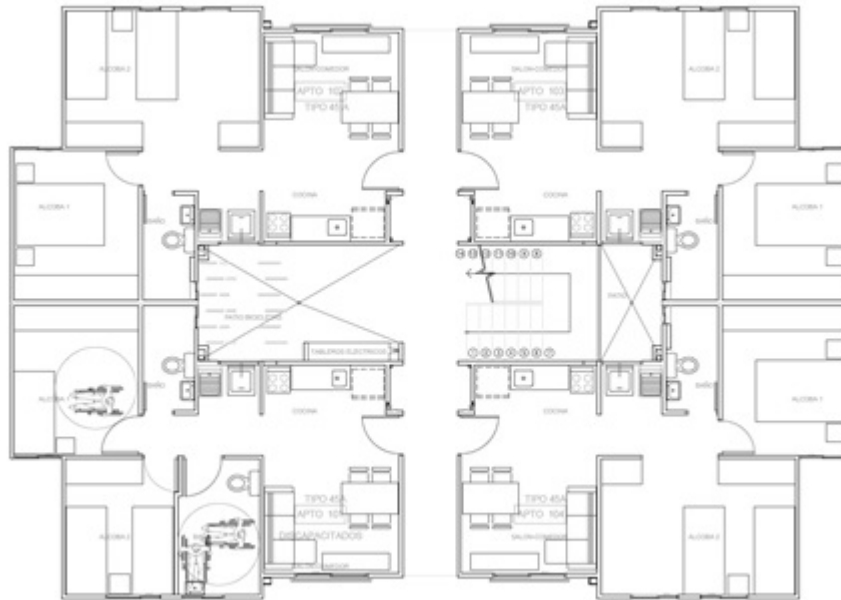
Planta tipo. Fuente Proyecto VIS - Sta. Martha.
